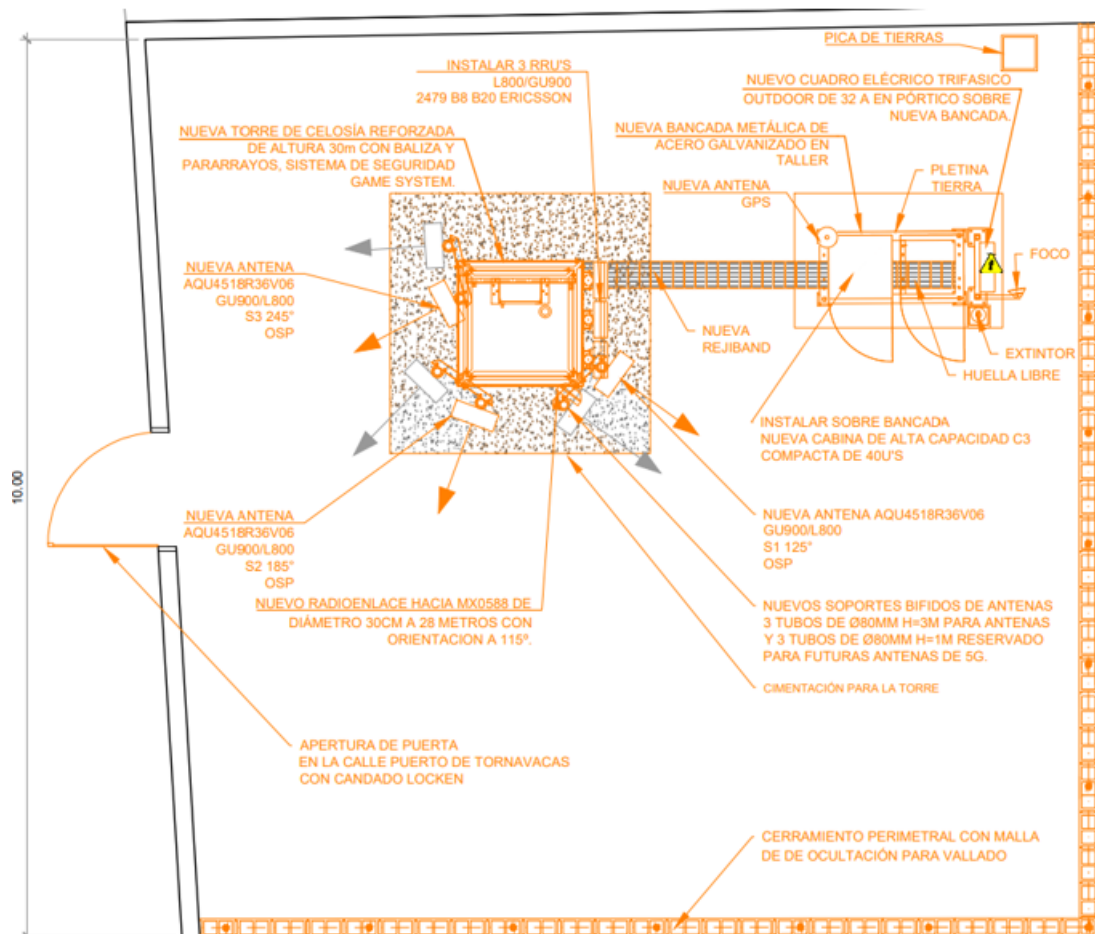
Distribución del emplazamiento planta. Elaboración propia.
